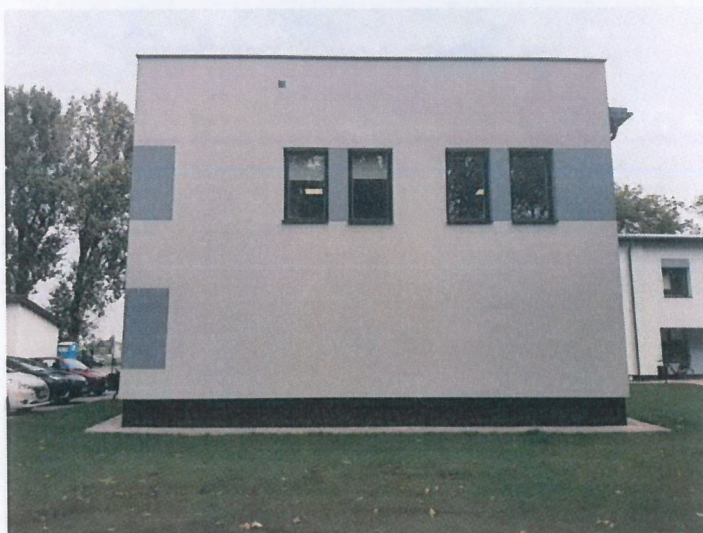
Widok fragmentu elewacji południowej / nowego skrzydła budynku.
